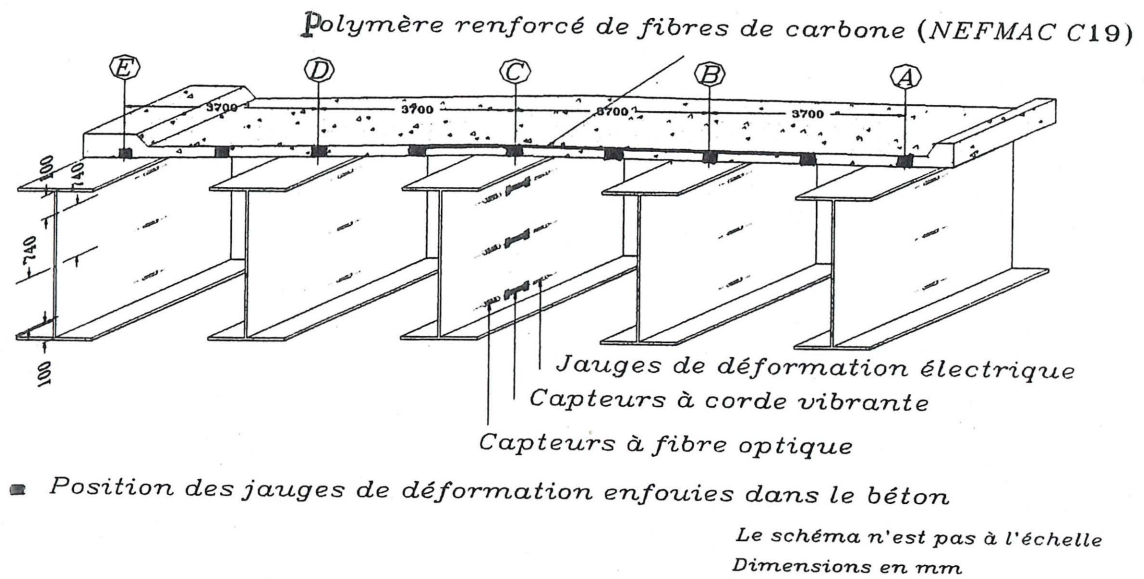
Types et positions des instruments de mesure installés sur les poutres d'acier et blocs de jauges électriques noyées dans la dalle de béton
